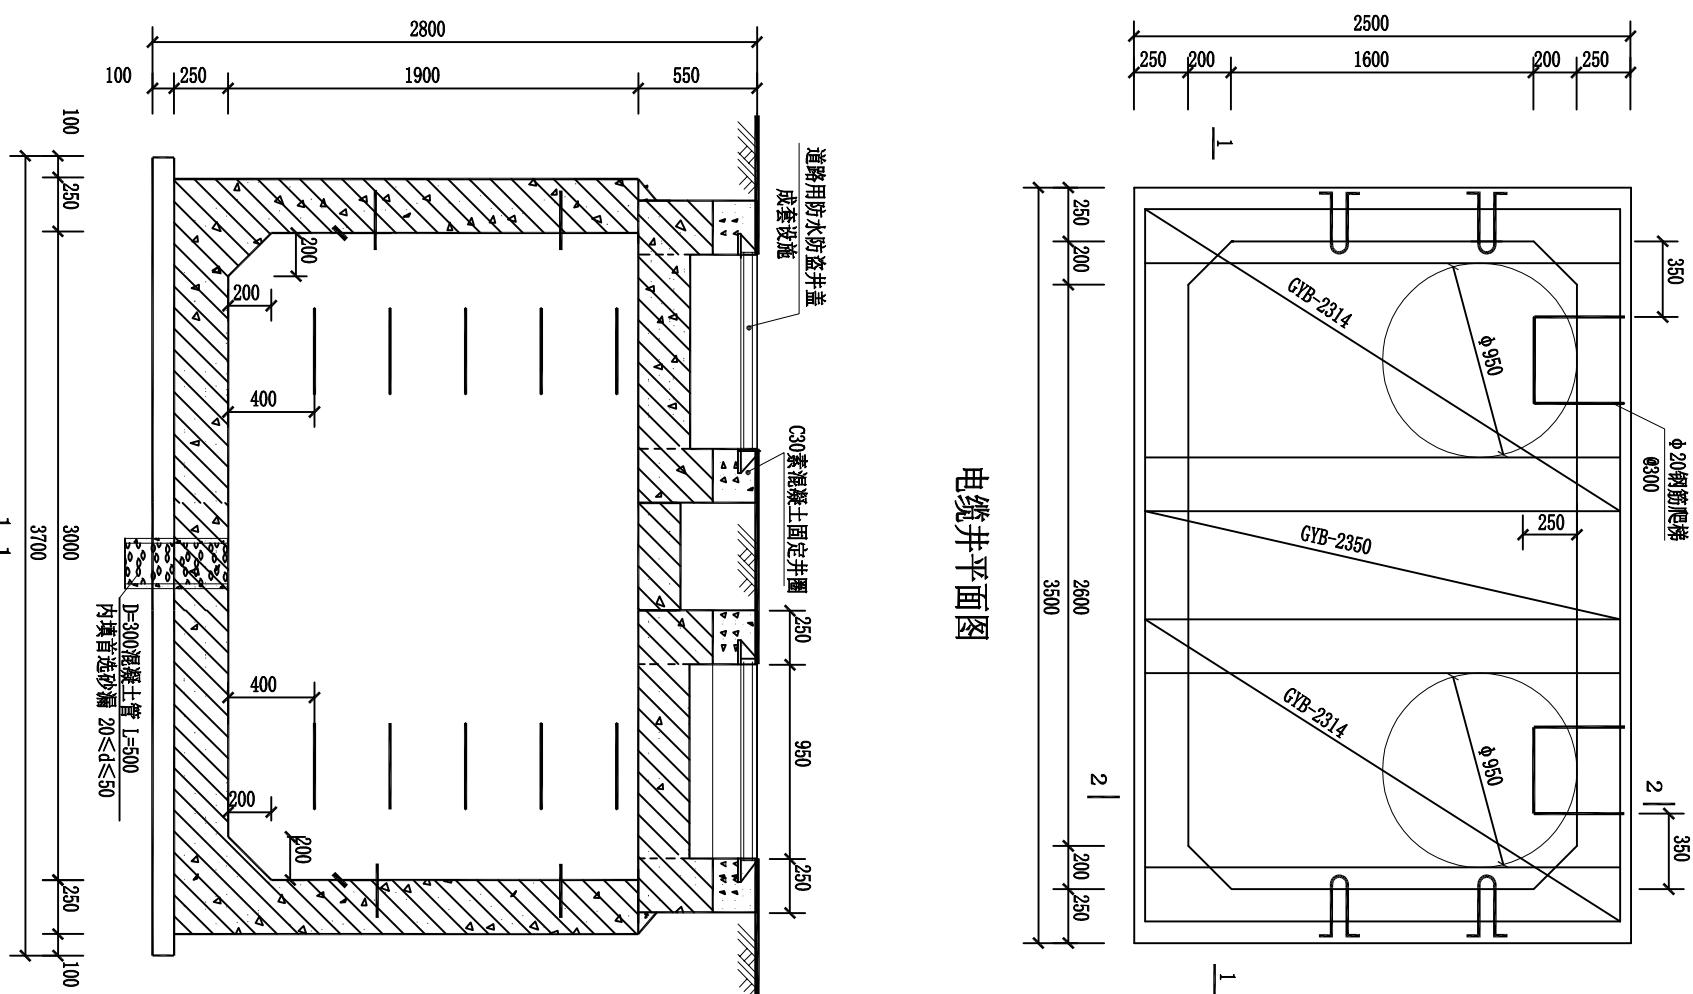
[3.0×2.0×1.9钢筋混凝土直线电缆井 (E-1-13) (-)]
